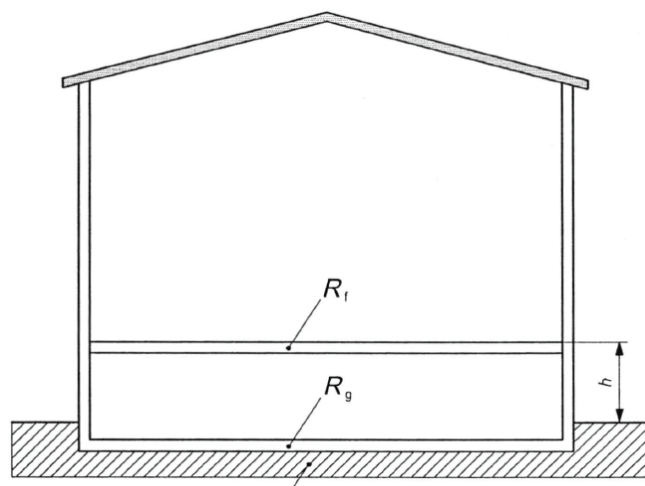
Схема будинку з перекриттям над вентиляльованим приміщенням.
